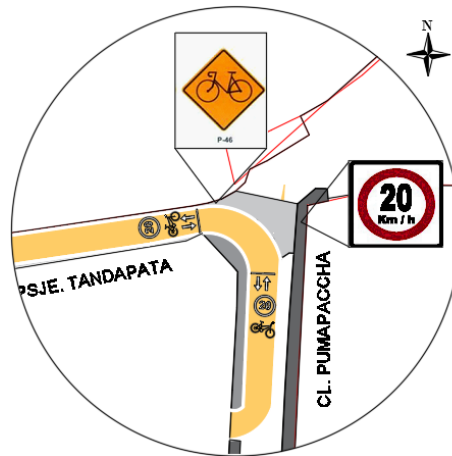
Propuesta en planta de Tandapata con Pumapaccha
